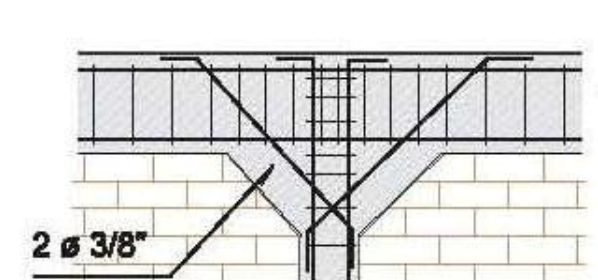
Recreido de la unión pilar-cadena (Kuroiwa, 2008)
